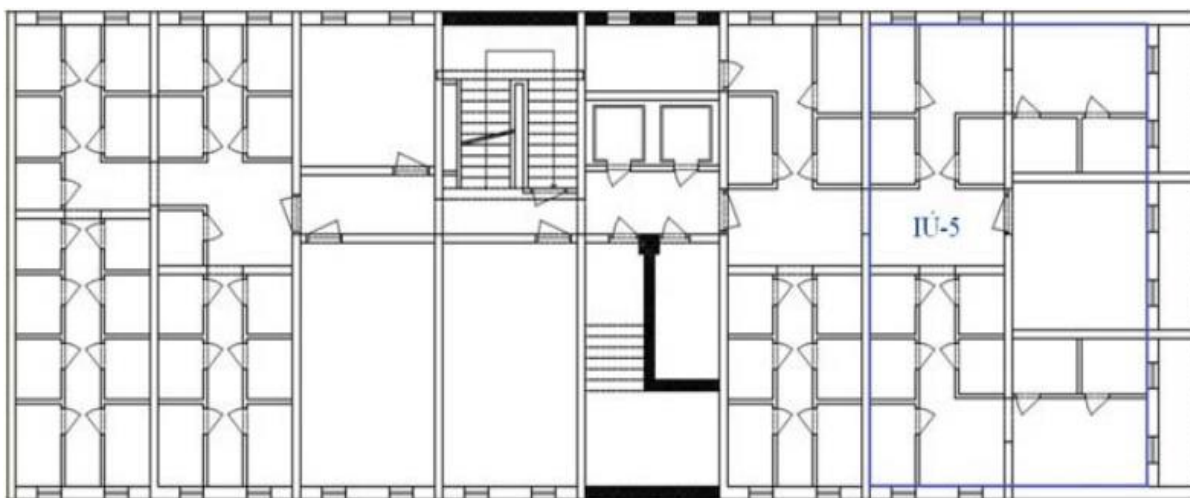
Půdorys vybraných prostor k ukrytí (Varianta 1)<sup>414</sup>. [Zdroj: Obr-239]
